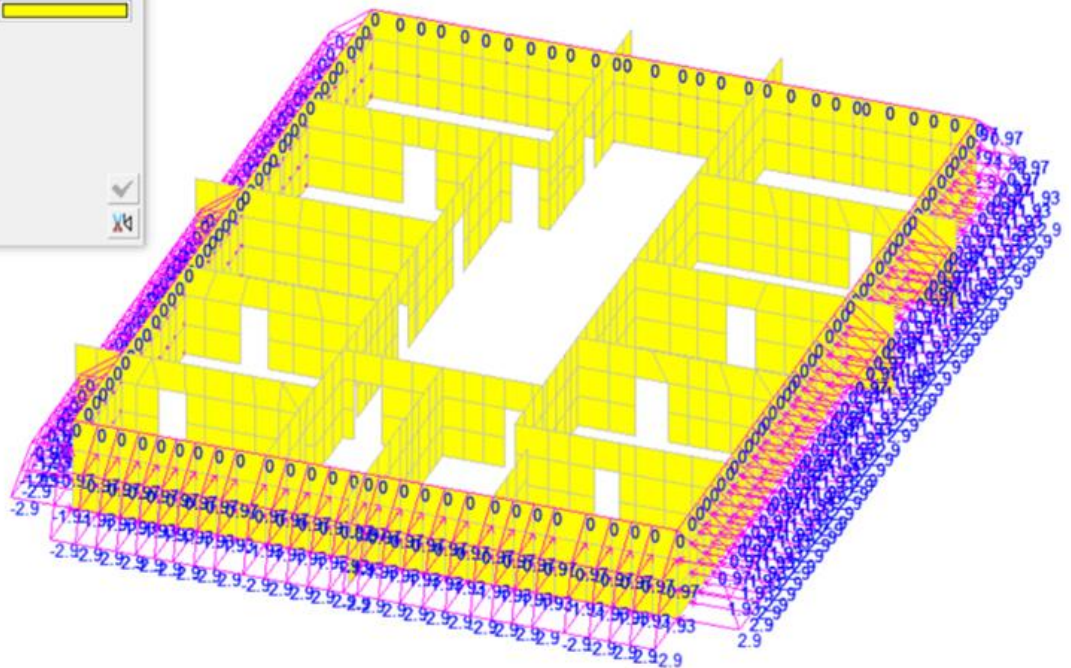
загрузка 3 – давление грунта на стены подвала
